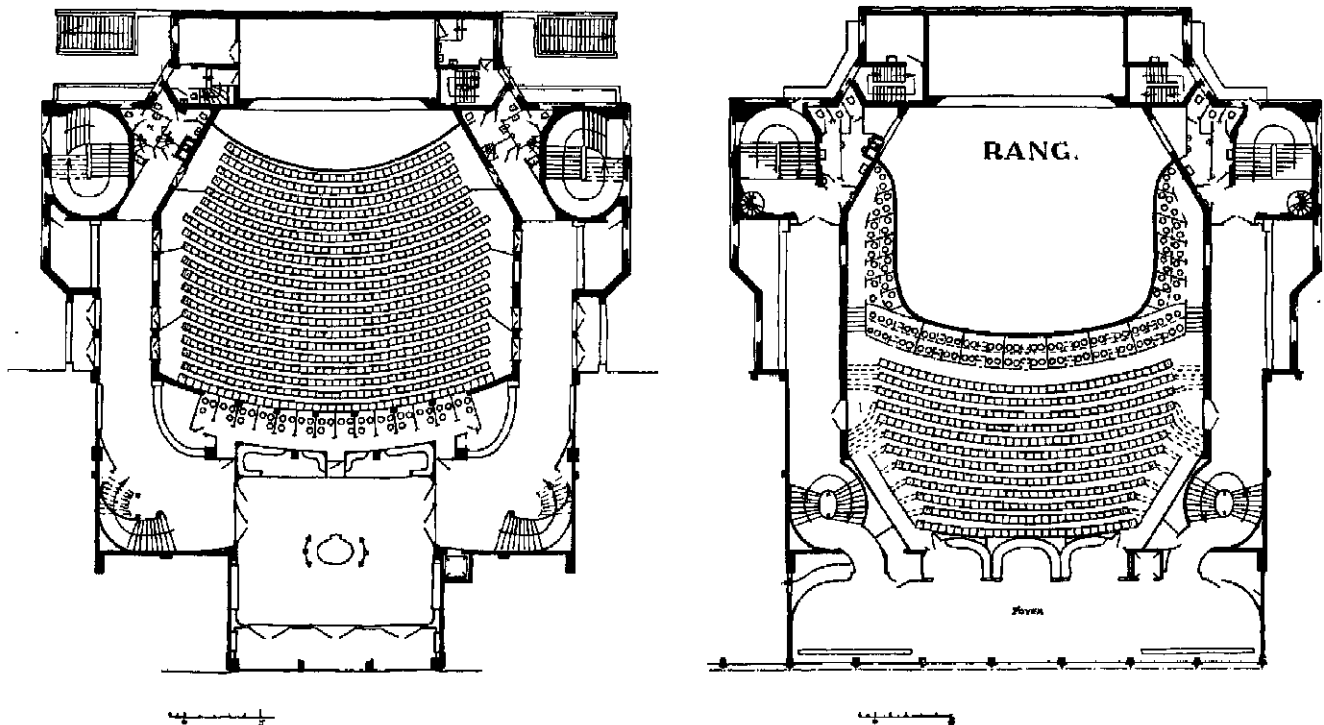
und 24 | Capitol, Berlin | Grundrisse vom Parkett und Rang des Lichtspieltheaters | Architekt: Hans Poelzig, Berlin
